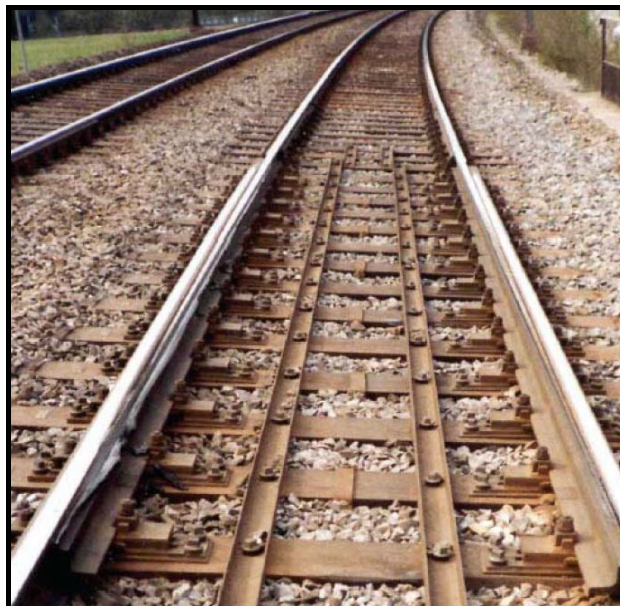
Aparato de dilatación, de tipo A, colocado para la protección de una vía de barra larga de una vía de barra corta. Fuente: Sistemas ferroviarios. JEZ.
